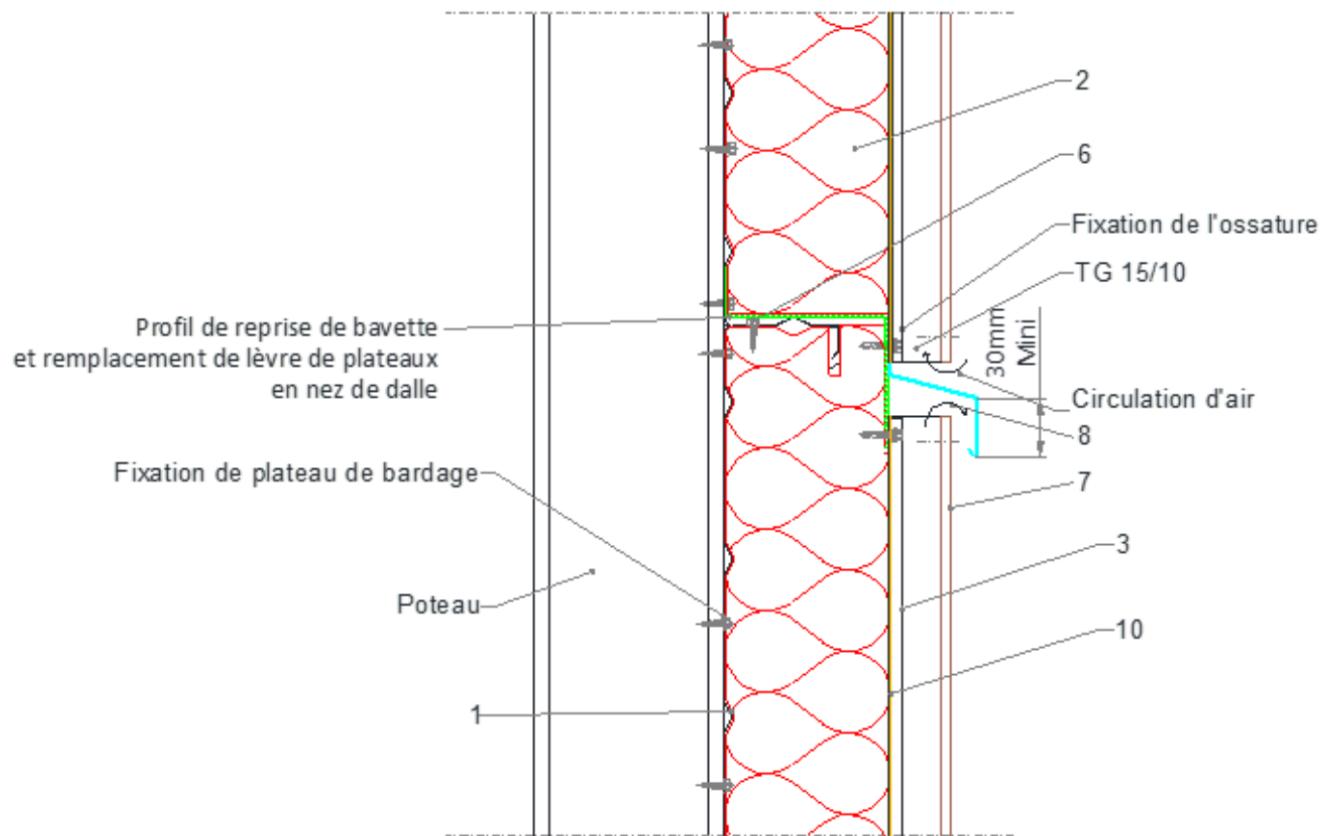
Fractionnement de lame d'air – Coupe verticale
